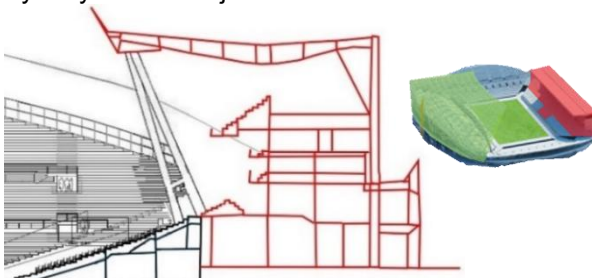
Przekrój A'-A' uzupełniony o elementy etapu 2, na zielono zaznaczono elementy nowe. Rysunek autora. Opracowane przez autora.
